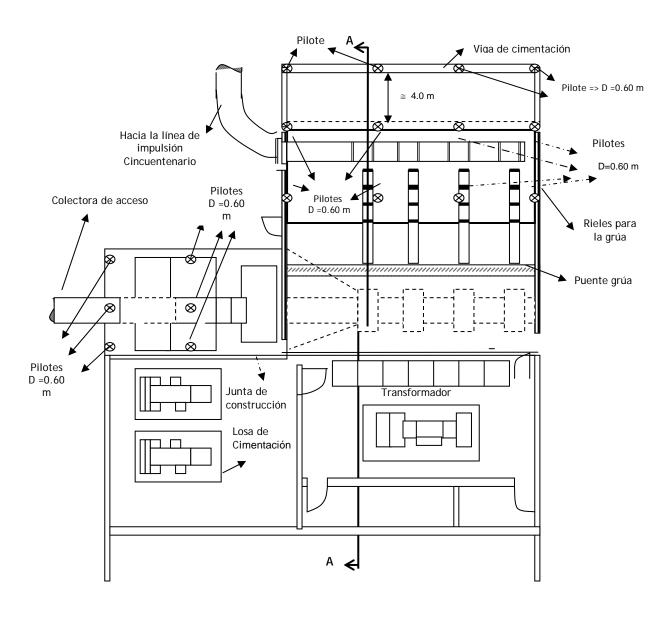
Estación de Bombeo Boca La Caja - Vista en Planta
